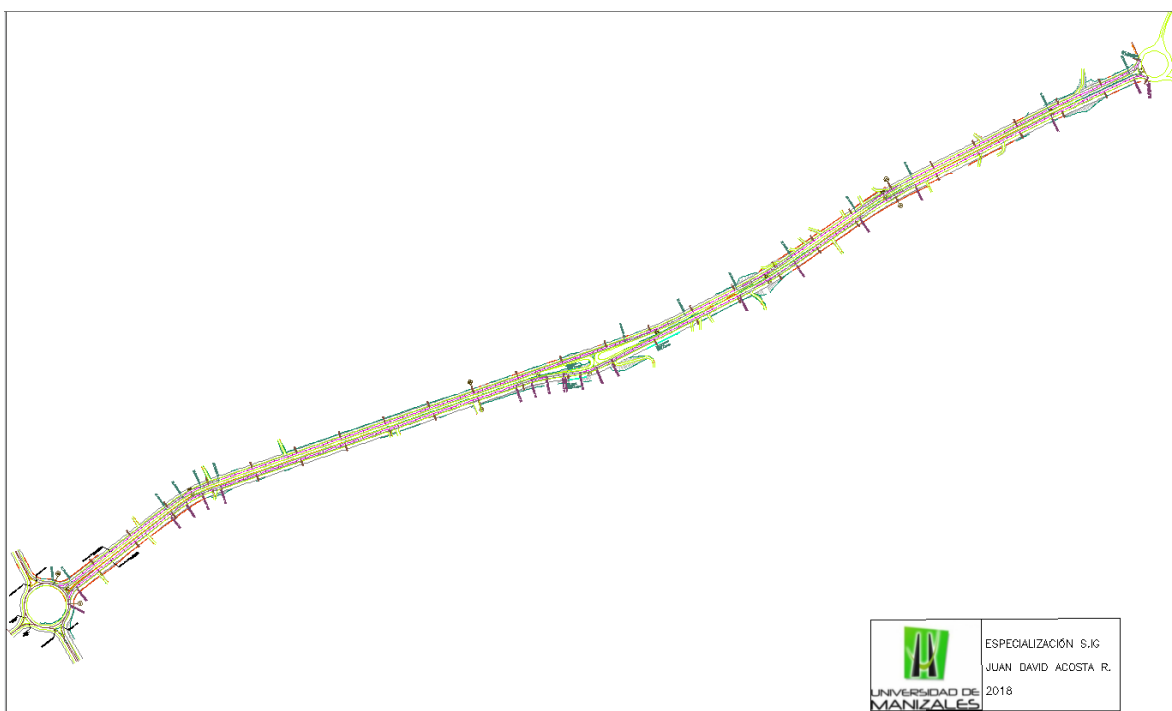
Diseño Vial del Tramo 6 del Plan Vial de Rionegro.¹⁹
